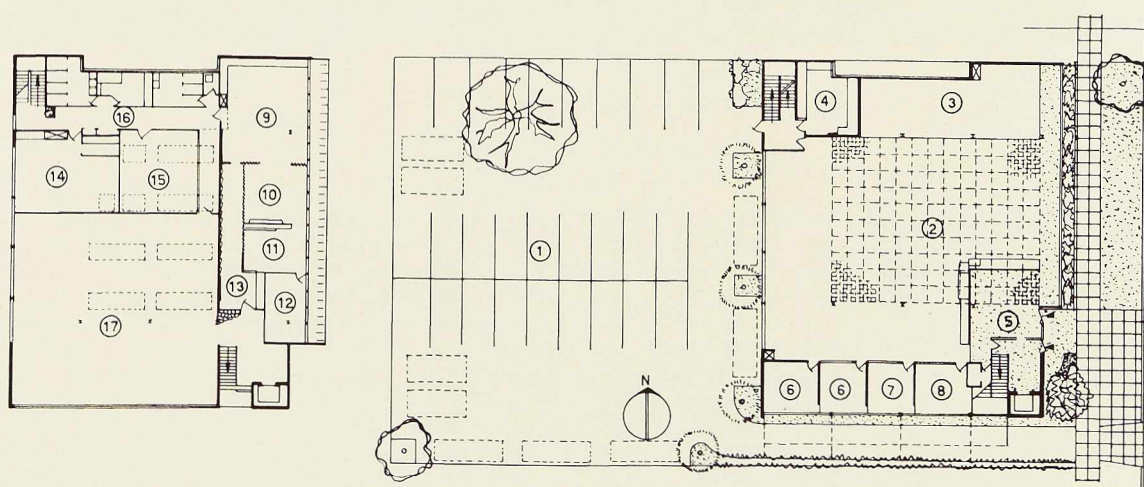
Plans du rez-de-chaussée et du premier étage du bâtiment de la N. M. F. A.
